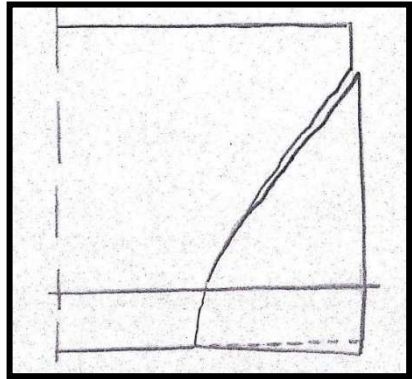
Asiento y giro de una esquina de una cimentación. Fuente: Propia.
